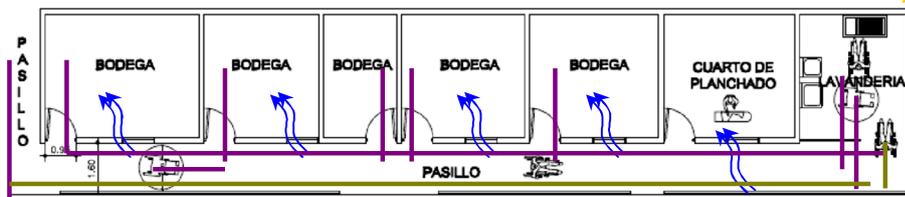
Planta Arquitectónica área de servicio./ Fuente: Propia
